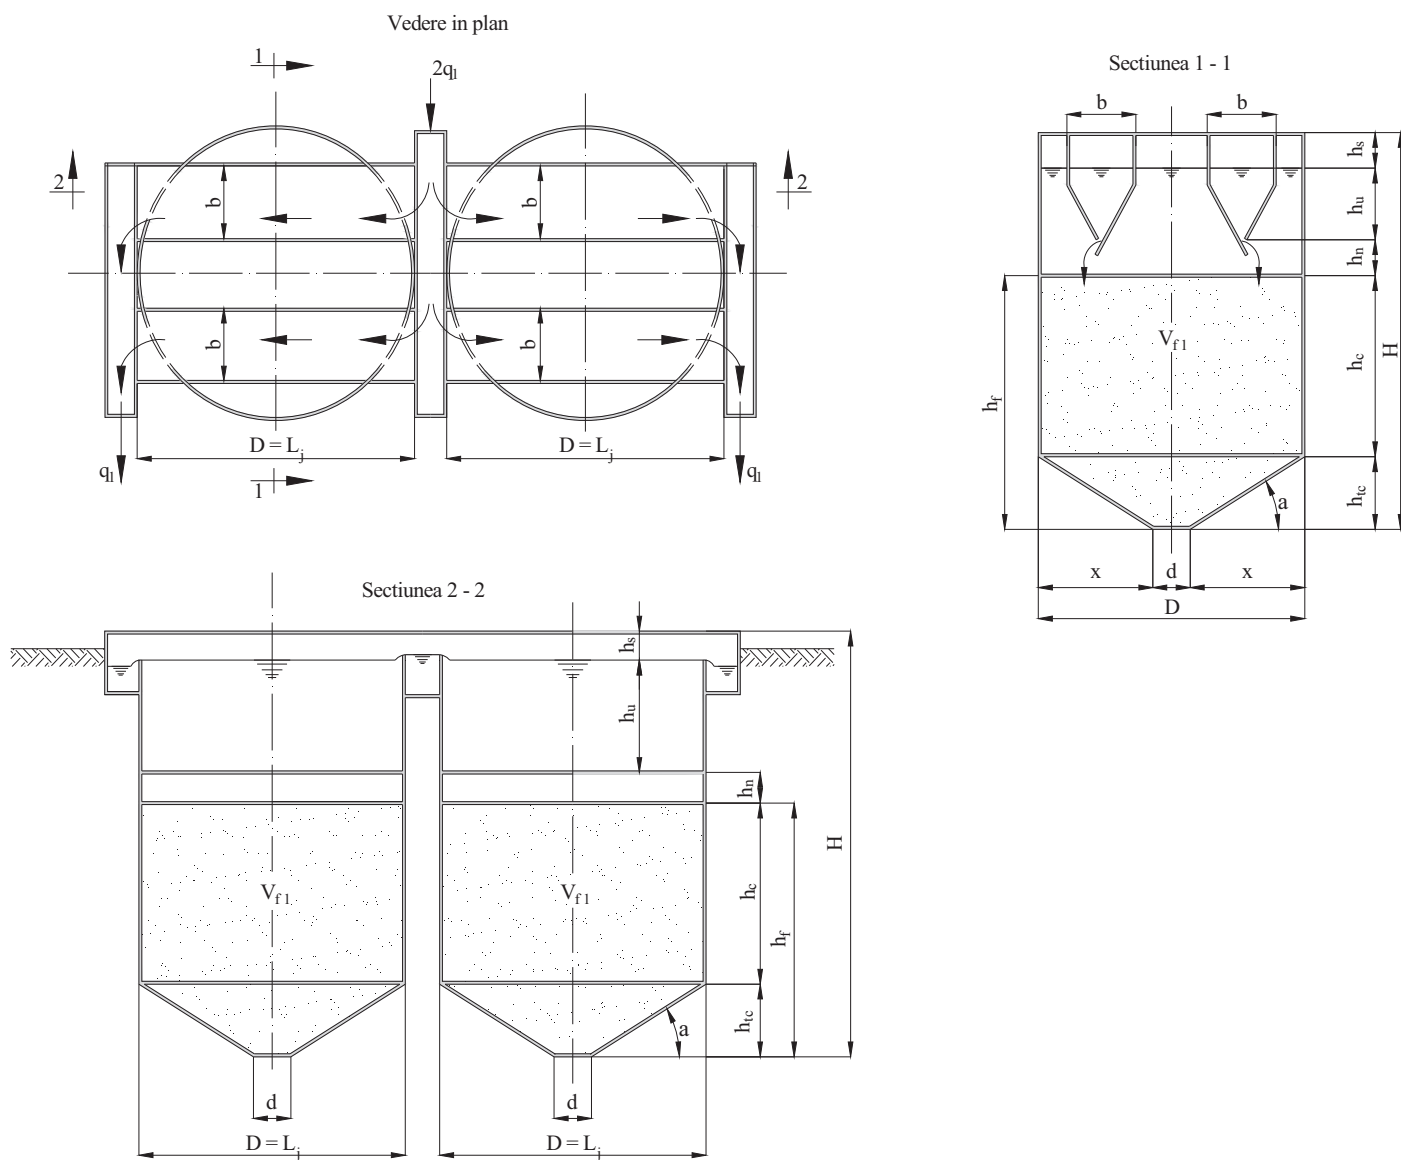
Decantoare cu etaj. Dispoziție în plan și secțiuni caracteristice.
